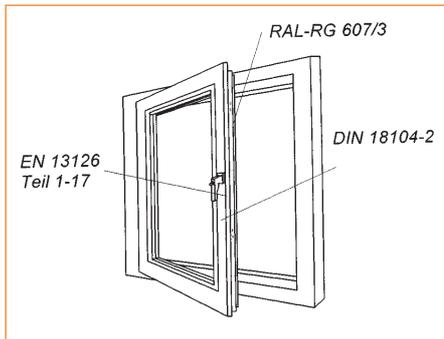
Normen und Prüfgrundlagen für Fensterbeschläge
